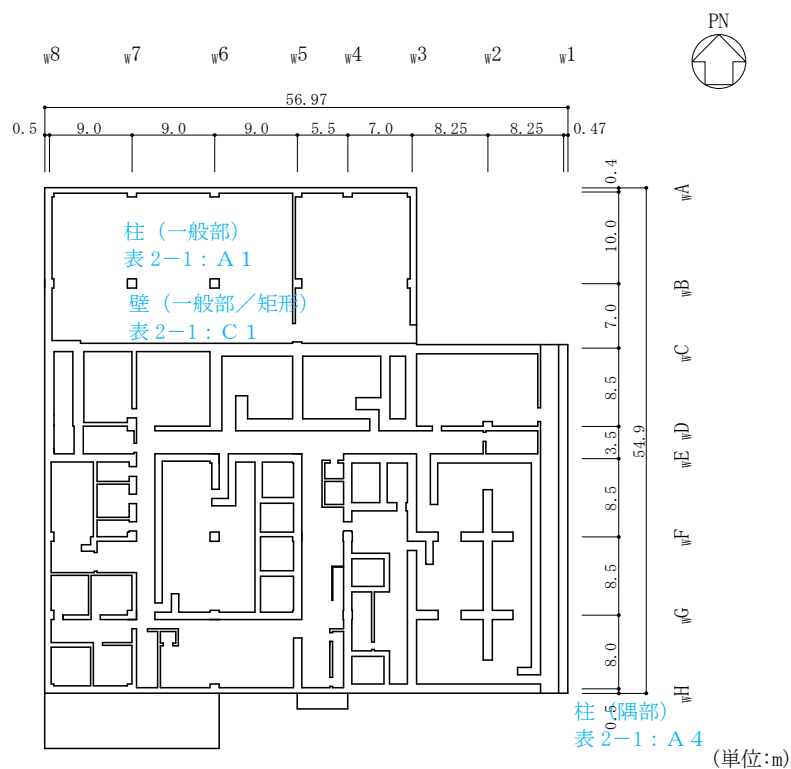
(5) 廃棄物処理建物の概略平面図 (EL 22.1m)
